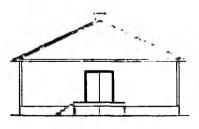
Фасадъ того же плодохранилища съ крыльцомъ.
